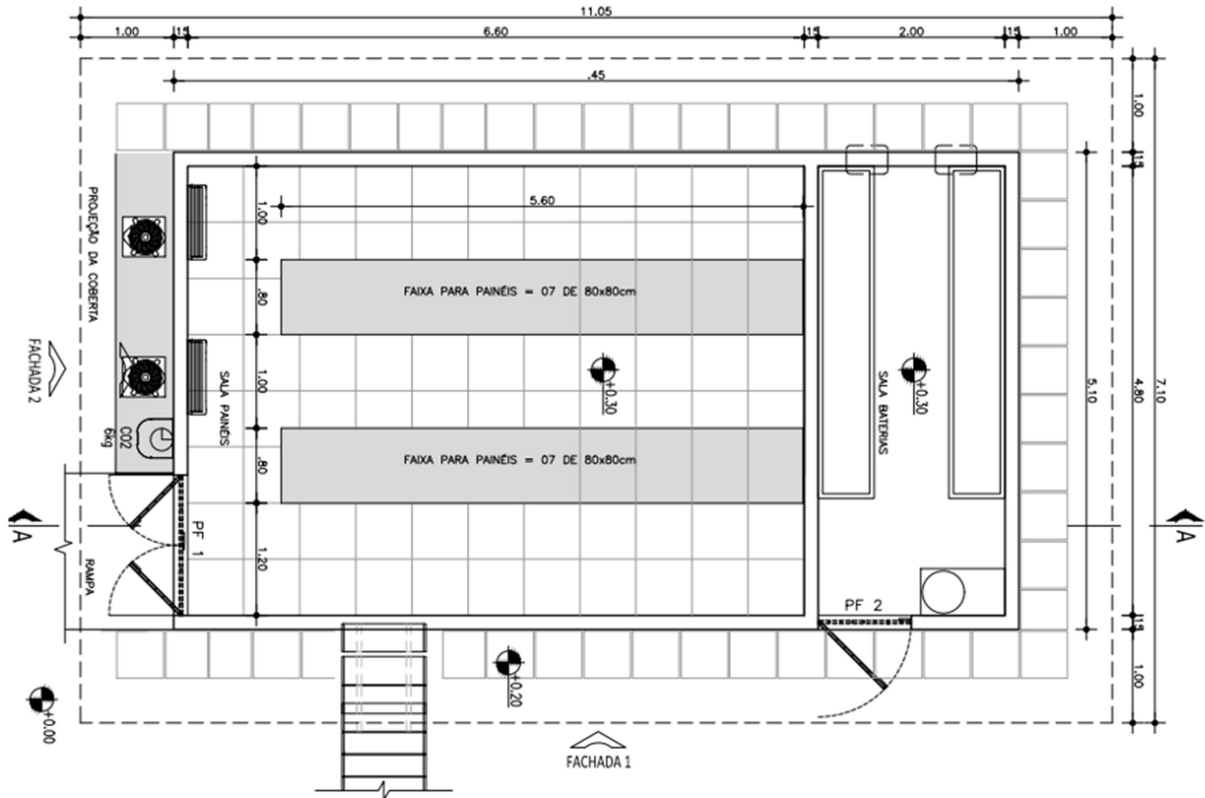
Edificação de comando e controle padrão para acessantes - Planta Baixa
